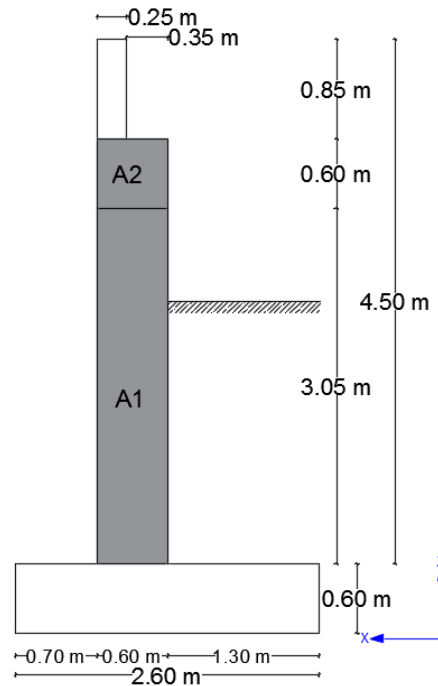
Alzado Transversal de la configuración y geometría del Estribo del Puente sobre el río Mocora (Vista X-Z)
